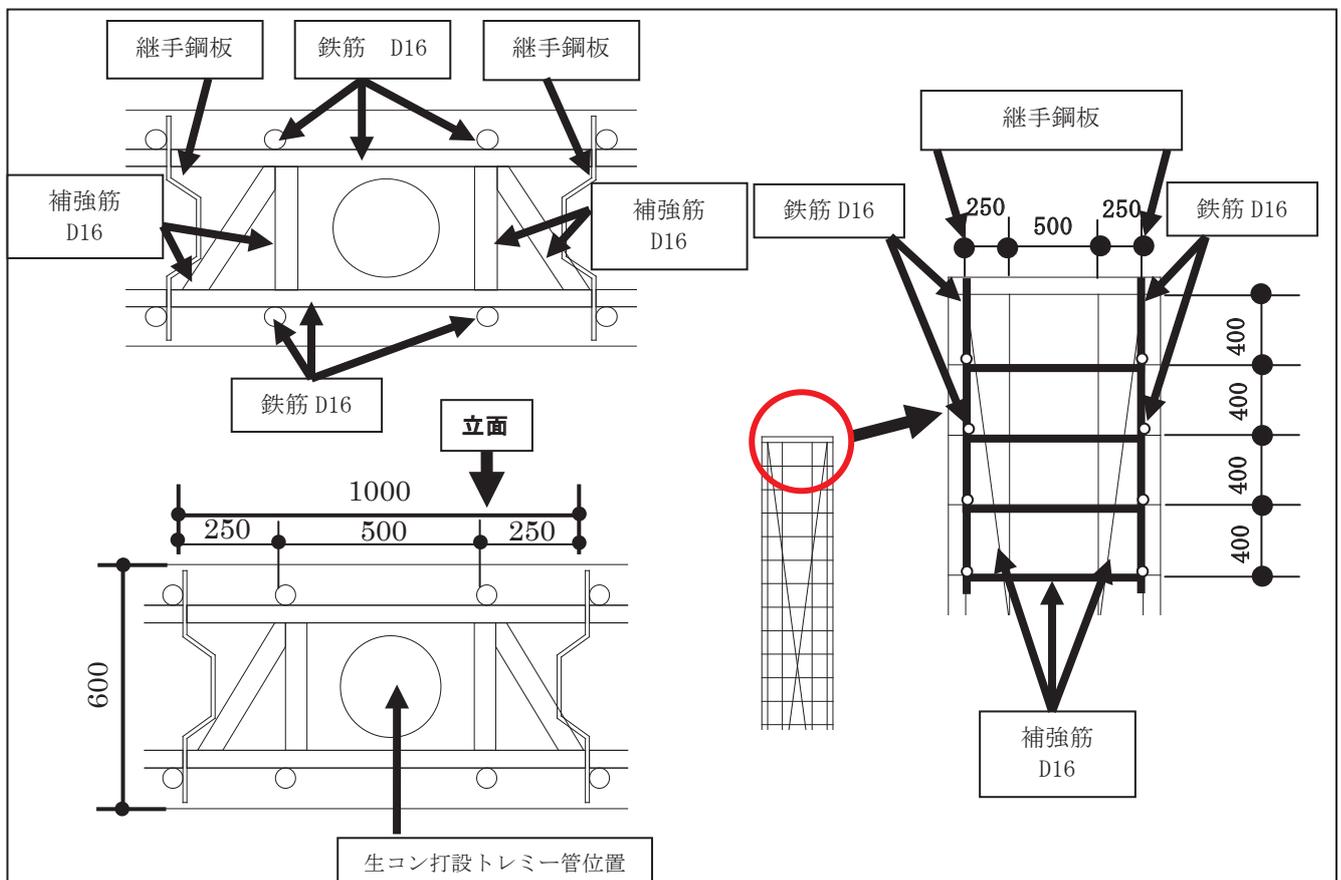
RCキングポスト配筋及びトレミー管位置平面詳細（左），立面詳細（右）
